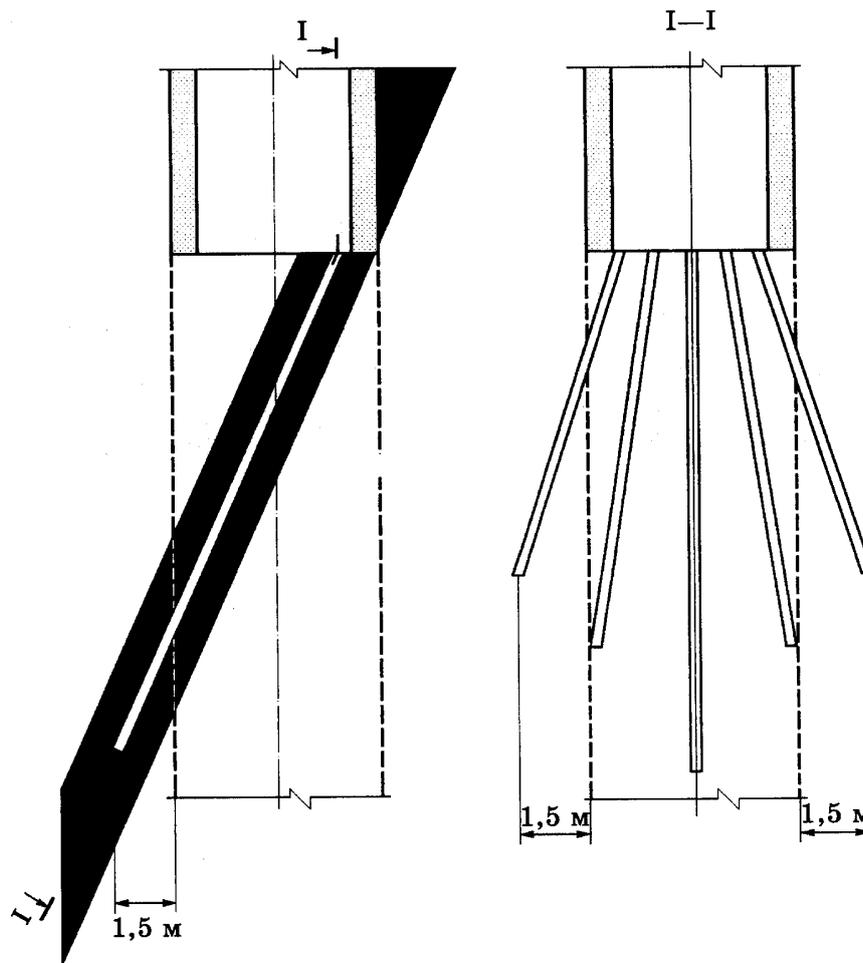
Схема расположения дренажных скважин при пересечении крутых пластов
